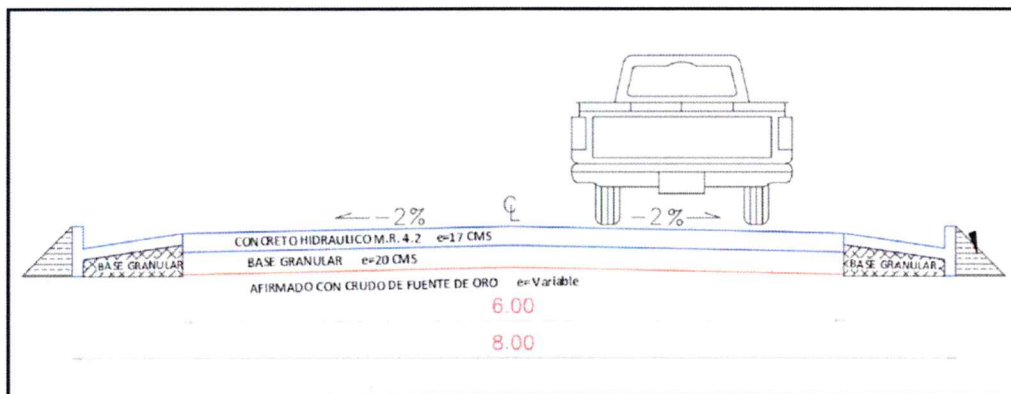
Diseño típico esquemático de la sección trasversal
